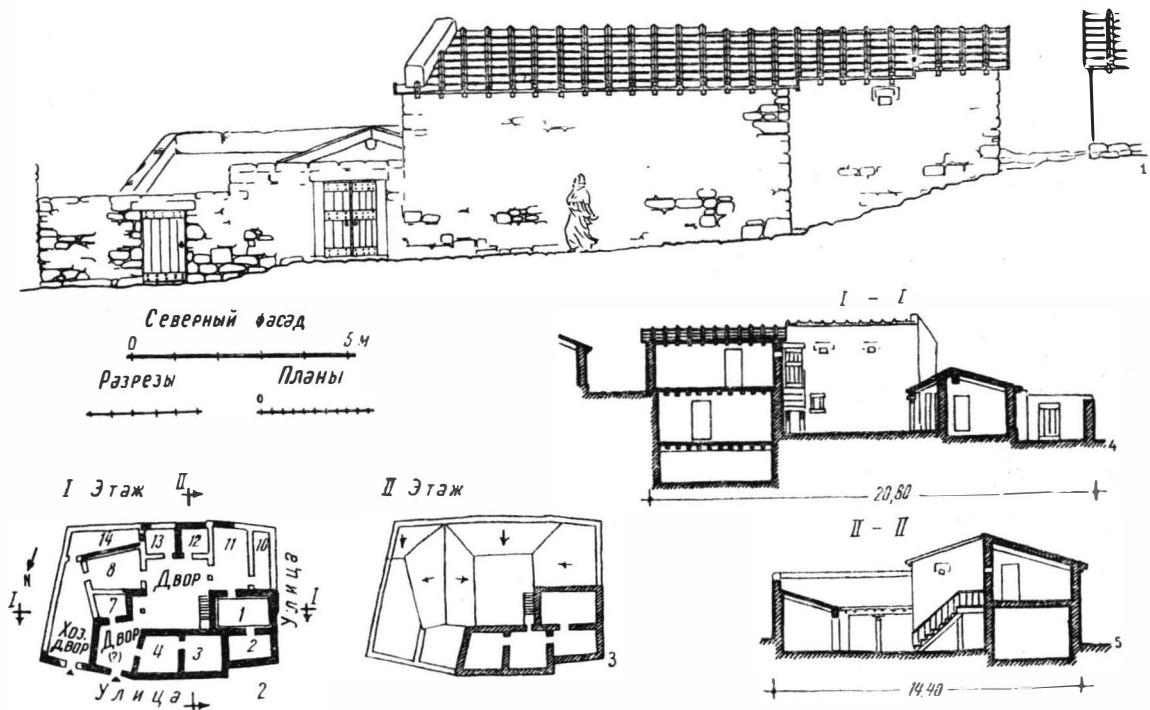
Участок И. Дом И-6. Реконструкция полутораэтажного варианта: 1, северный фасад; 2, план первого этажа; 3, план второго этажа; 4, 5, Разрезы.
